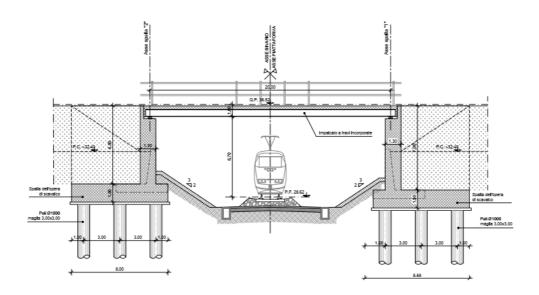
Cavalcaferrovia NW02 – Sezione longitudinale
